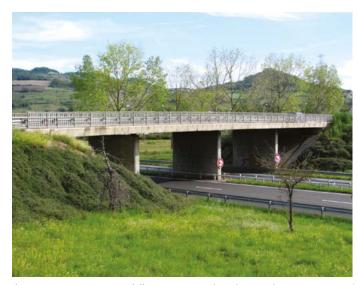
Passage supérieur dalle précontrainte (PSDP) - A 75 (Source : © Cerema)
